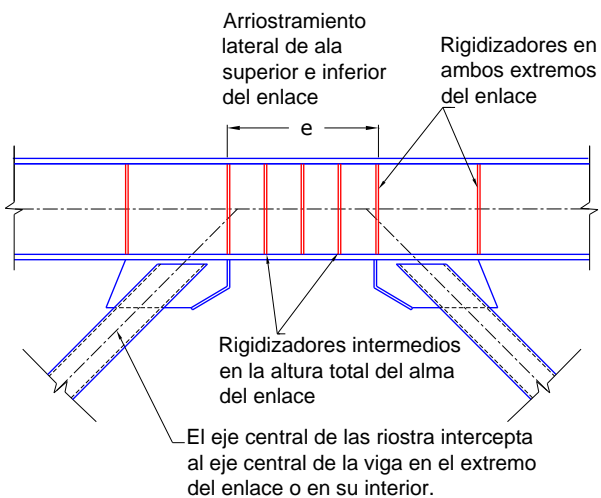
Detalle del enlace en la zona central de la viga con riostras formadas por secciones tubulares.
